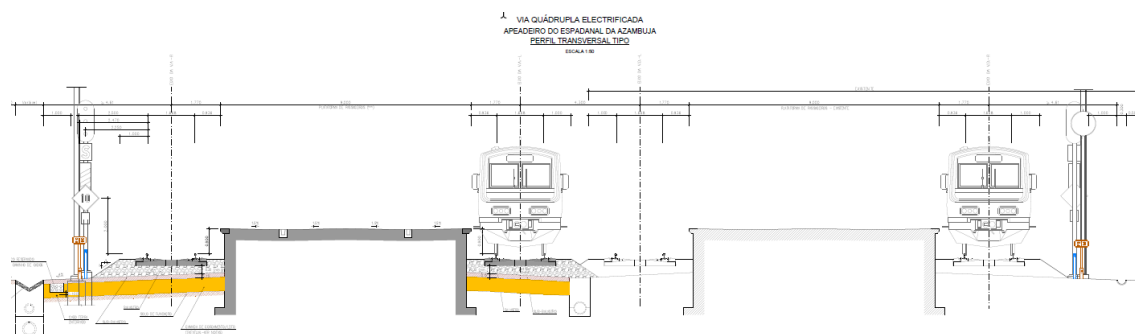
Perfil Transversal Tipo – Apeadeiro do Espadanal da Azambuja
